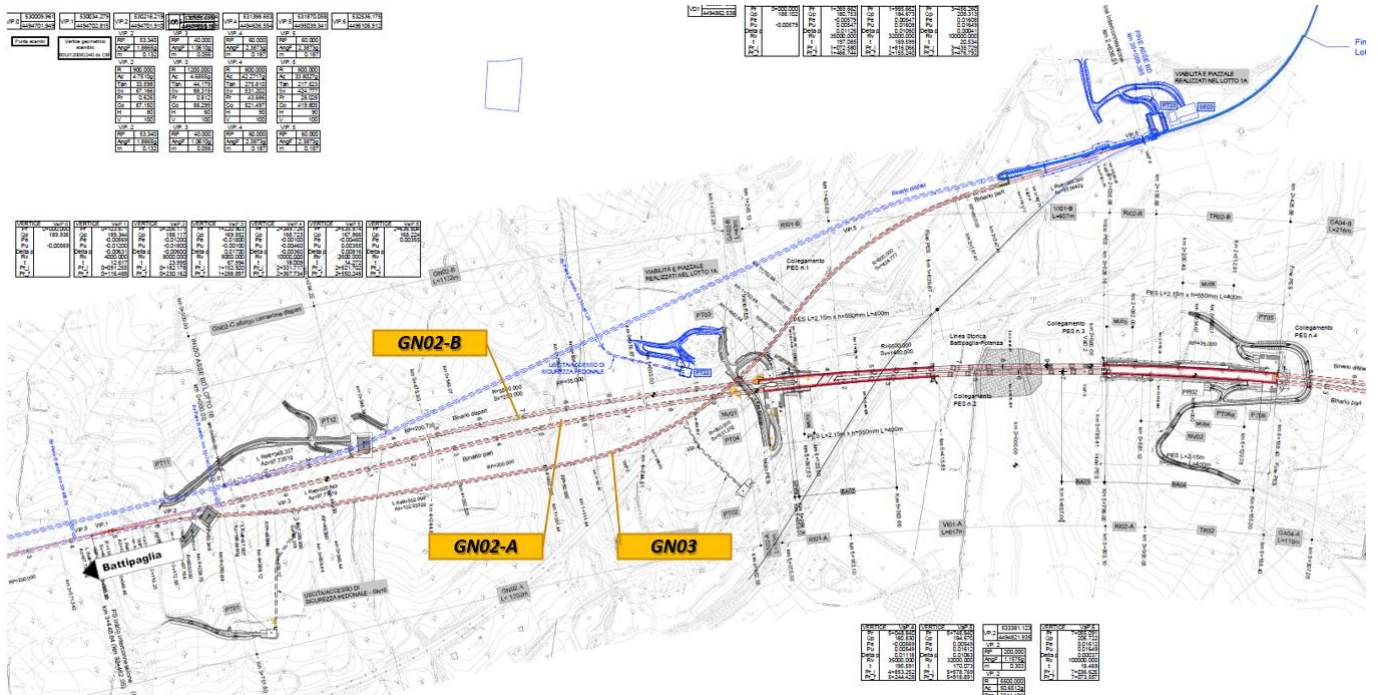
Planimetria di progetto da km 3+750 a km 6+188 BP
